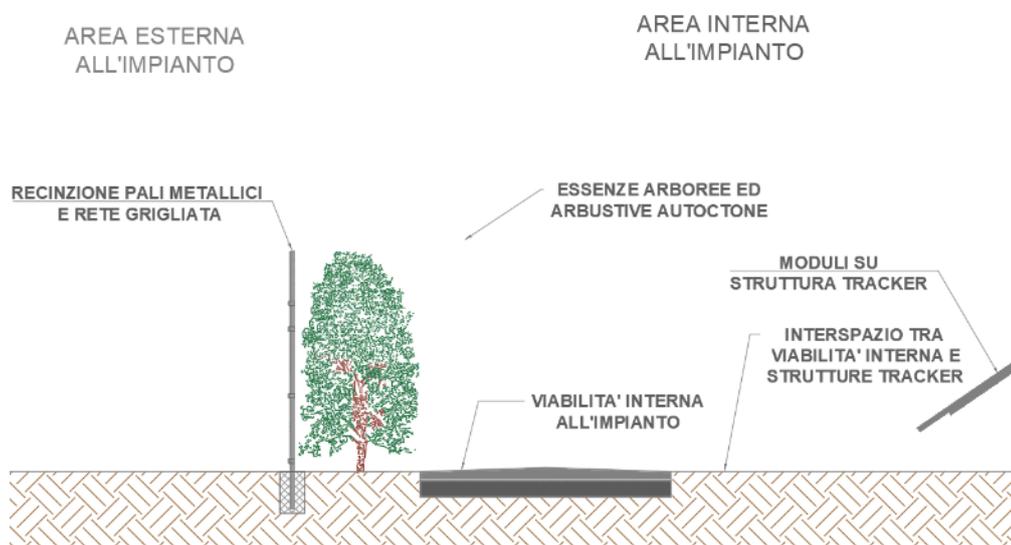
Sezione tipo fascia di mitigazione perimetrale
